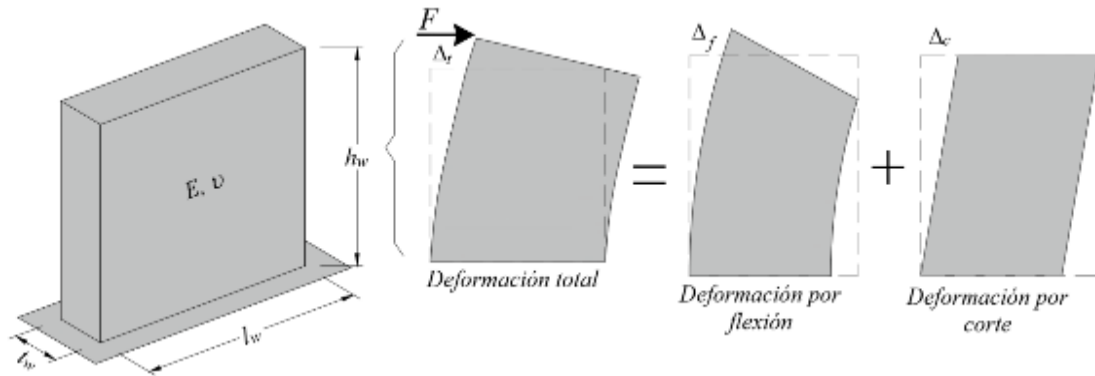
Deformación de un muro en voladizo bajo fuerza lateral
